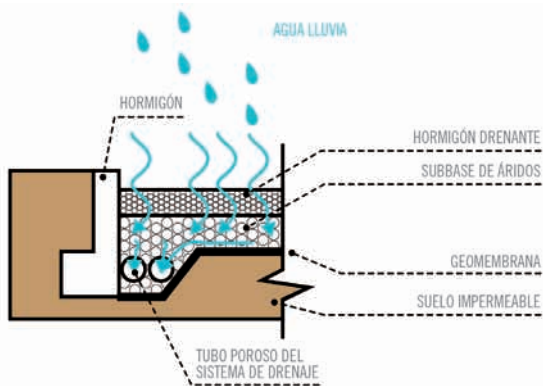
PAVIMENTO PERMEABLE CON INFILTRACIÓN
